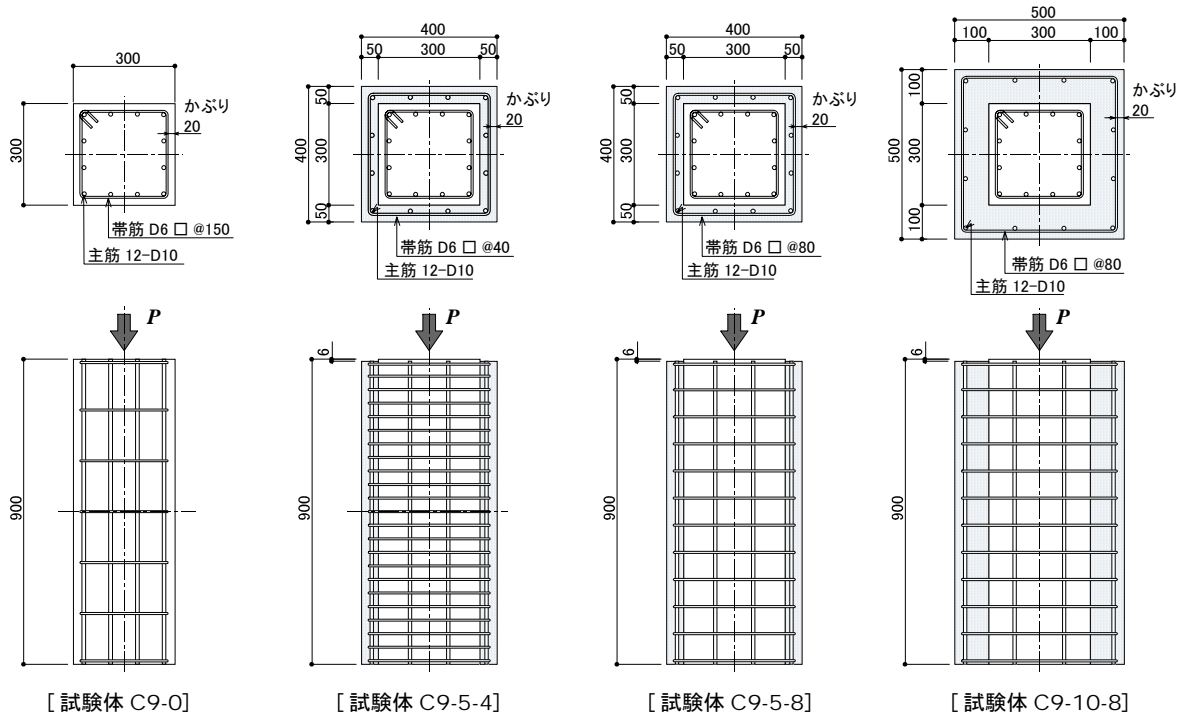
試験体の形状および配筋（中心圧縮実験）（単位；mm）
